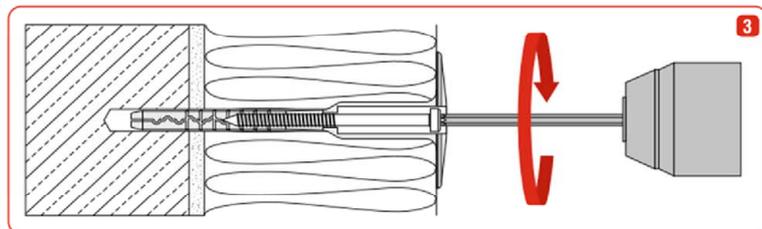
und 4 Die Spezialschraube mit dem Schraubendreher und Bit-Typ TX-30 mit entsprechender Länge eindrehen.
